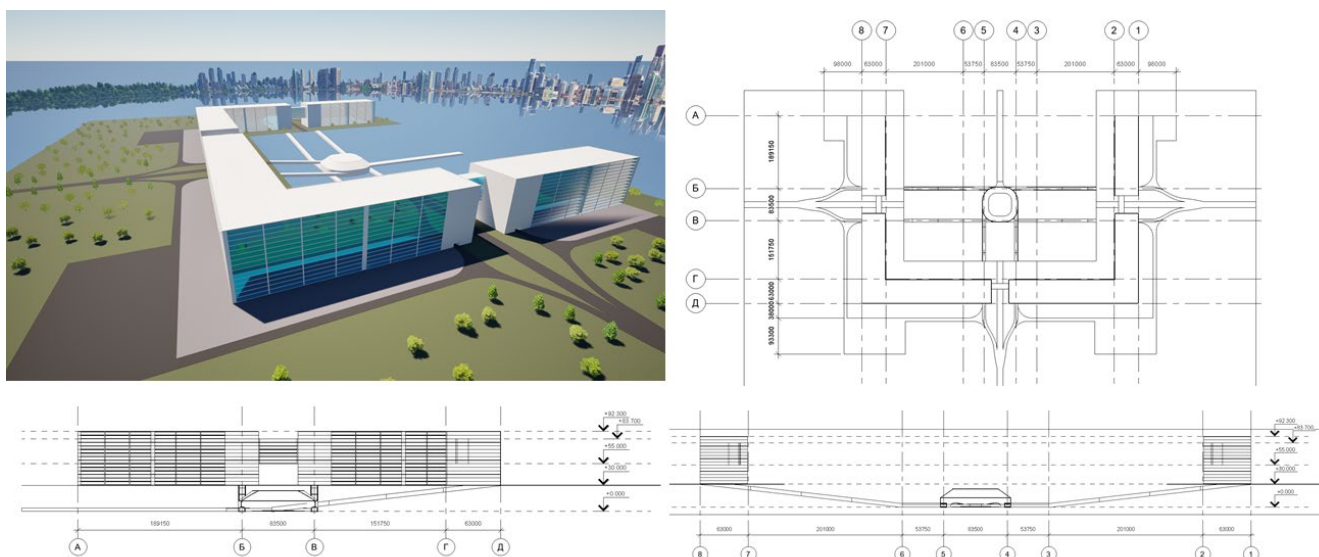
Общий вид цифровой модели, план на отметке 0.0, фасад А-Д по оси 1, разрез 1-1
